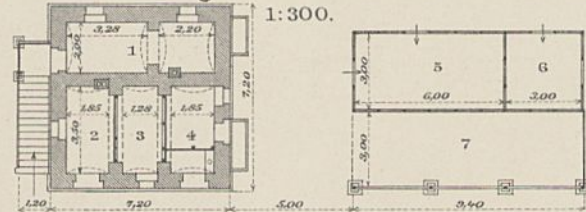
u. 9. Grundrisse des Erdgeschosses.
